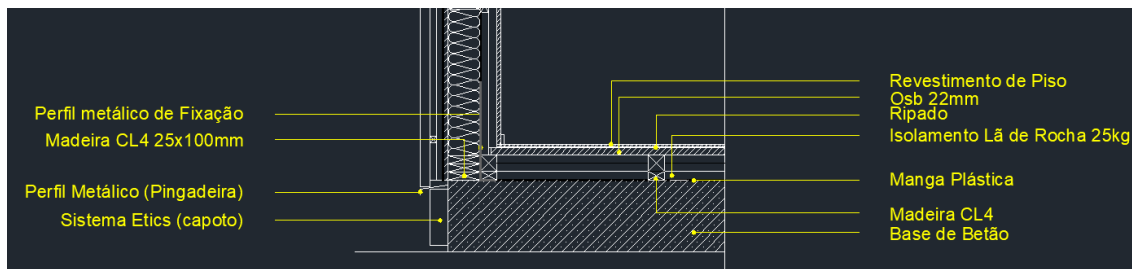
Pormenor da ligação entre a parede e o pavimento
